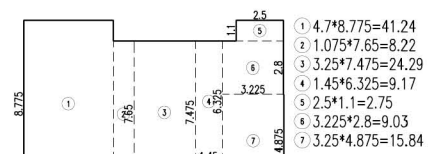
屋突二層平面圖 (比例尺 1/200)
